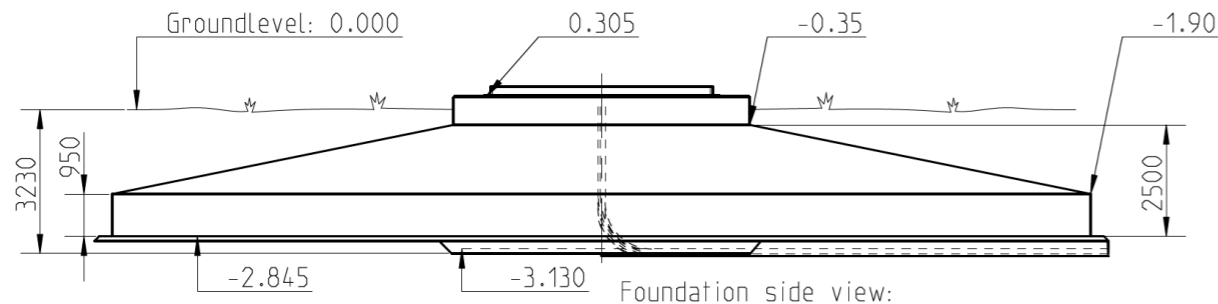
Illustration en coupe d'une fondation d'éolienne - WPD
